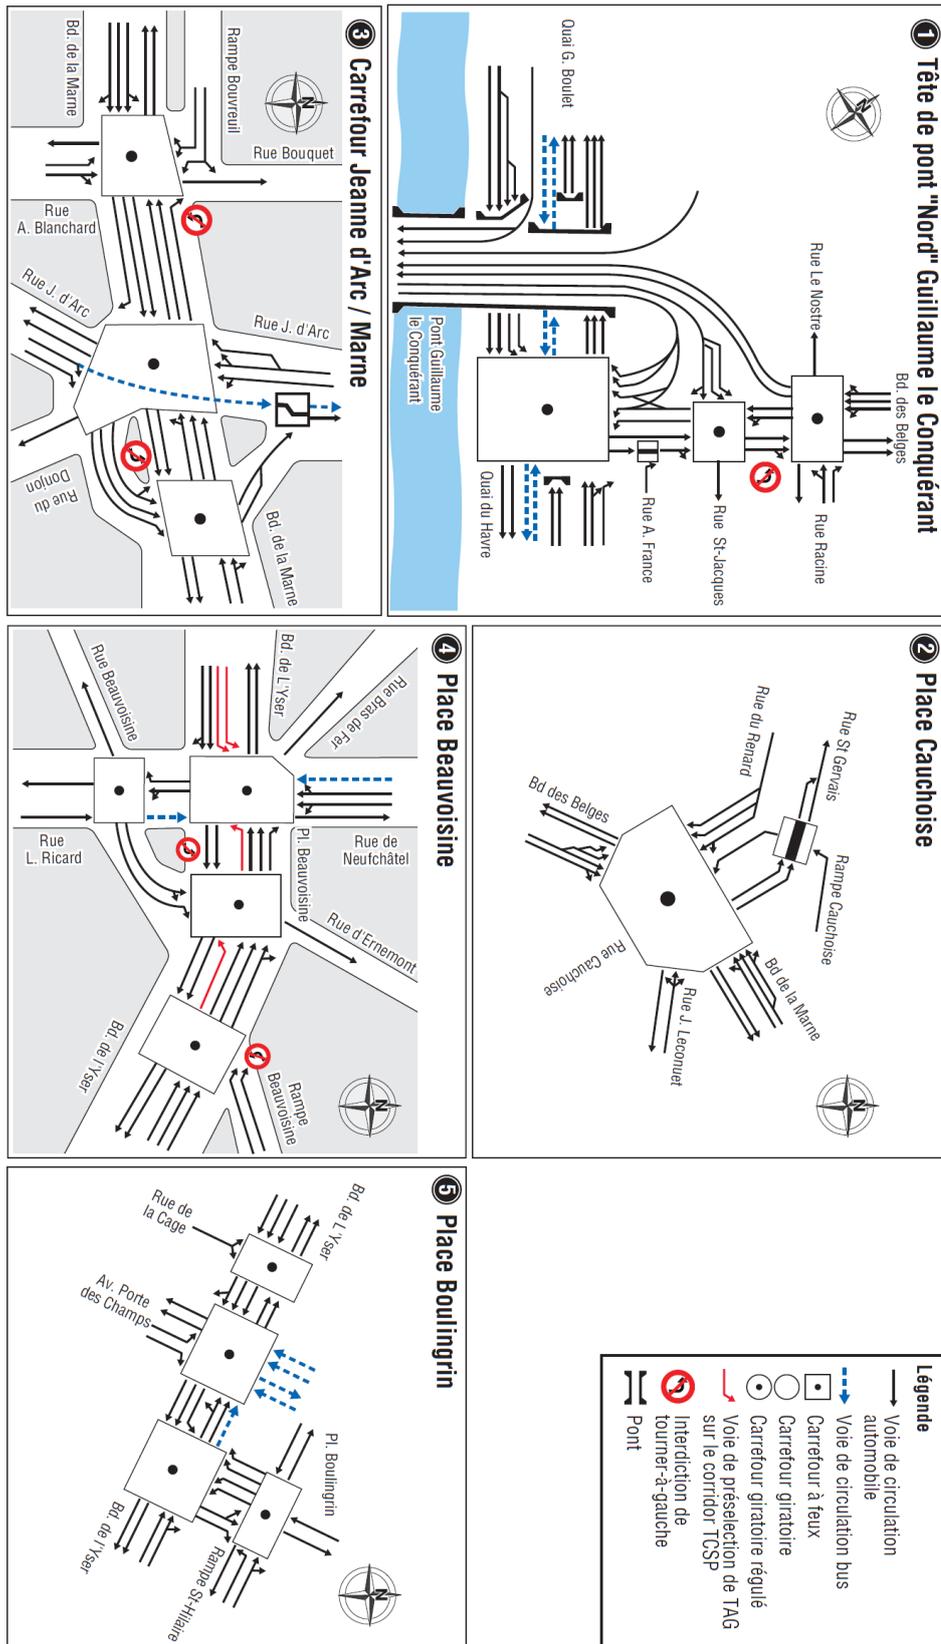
Plan des voies actuel – Zooms sur les principaux carrefours
